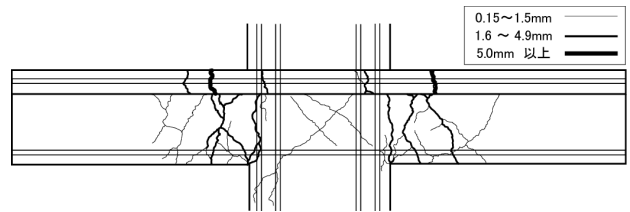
補修の対象となるひび割れ状況 (RCB)
